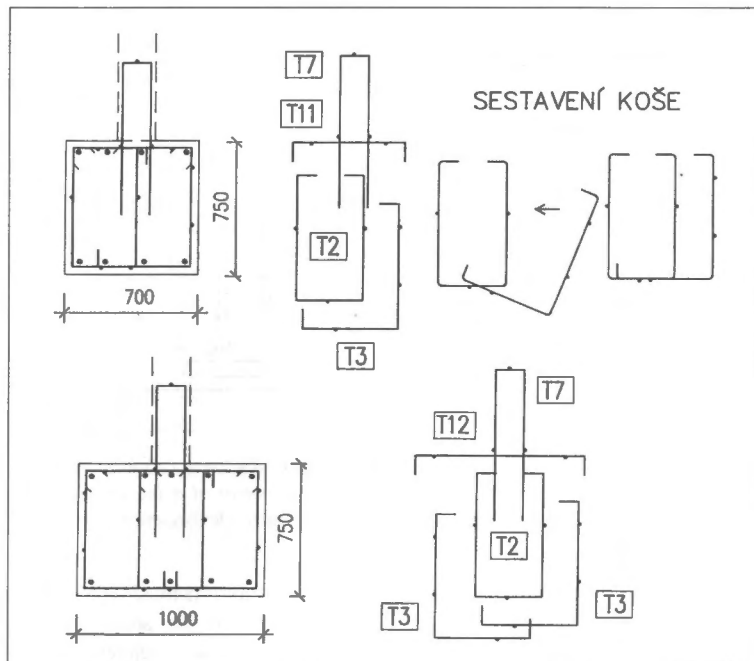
Zesílení smykové výztuže zdvojením stejných třmínkových prvků / Strengthening of the shear reinforcement by duplication of stirrup elements
